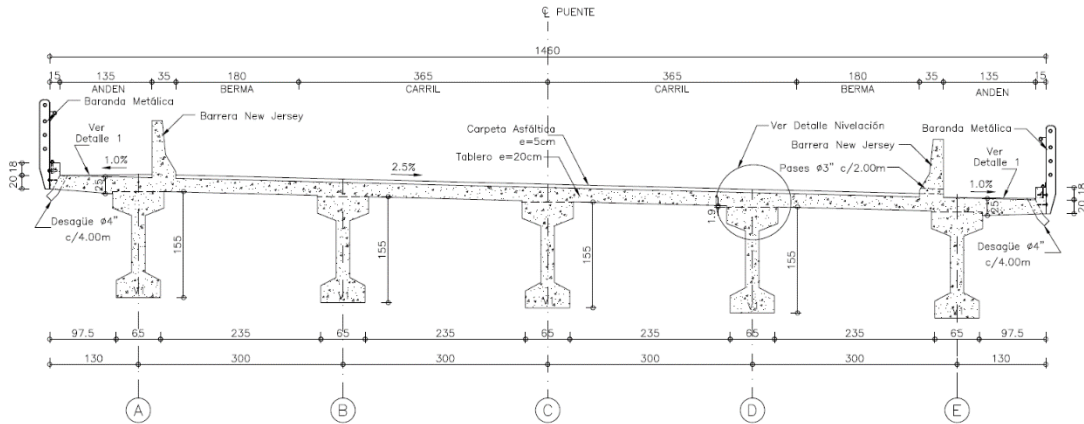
Sección transversal de la superestructura del puente San Pedro.
